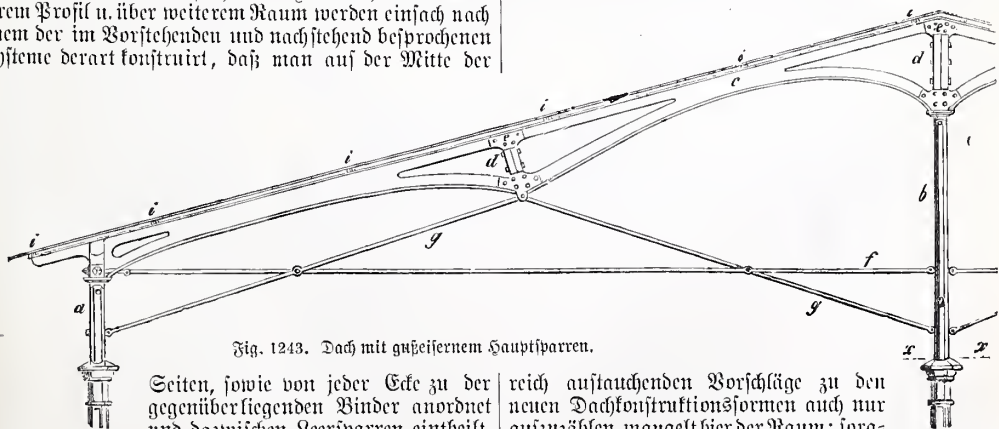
Dach mit gußeisernem Hauptsparren.
